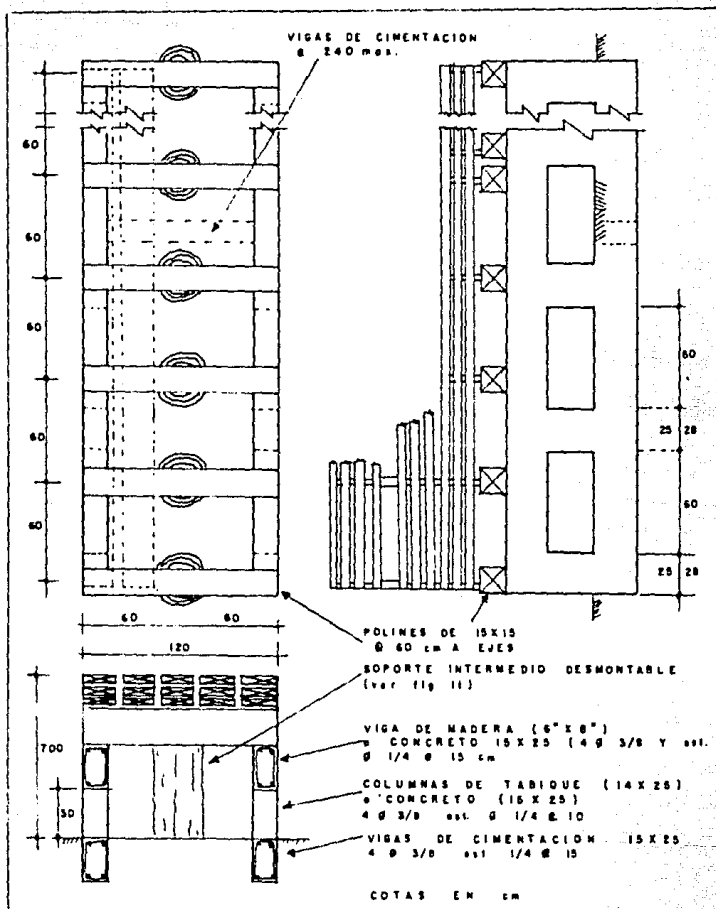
Construcción de una pila con soportes fijos para secado al aire en patios con manejo por montacargas.
